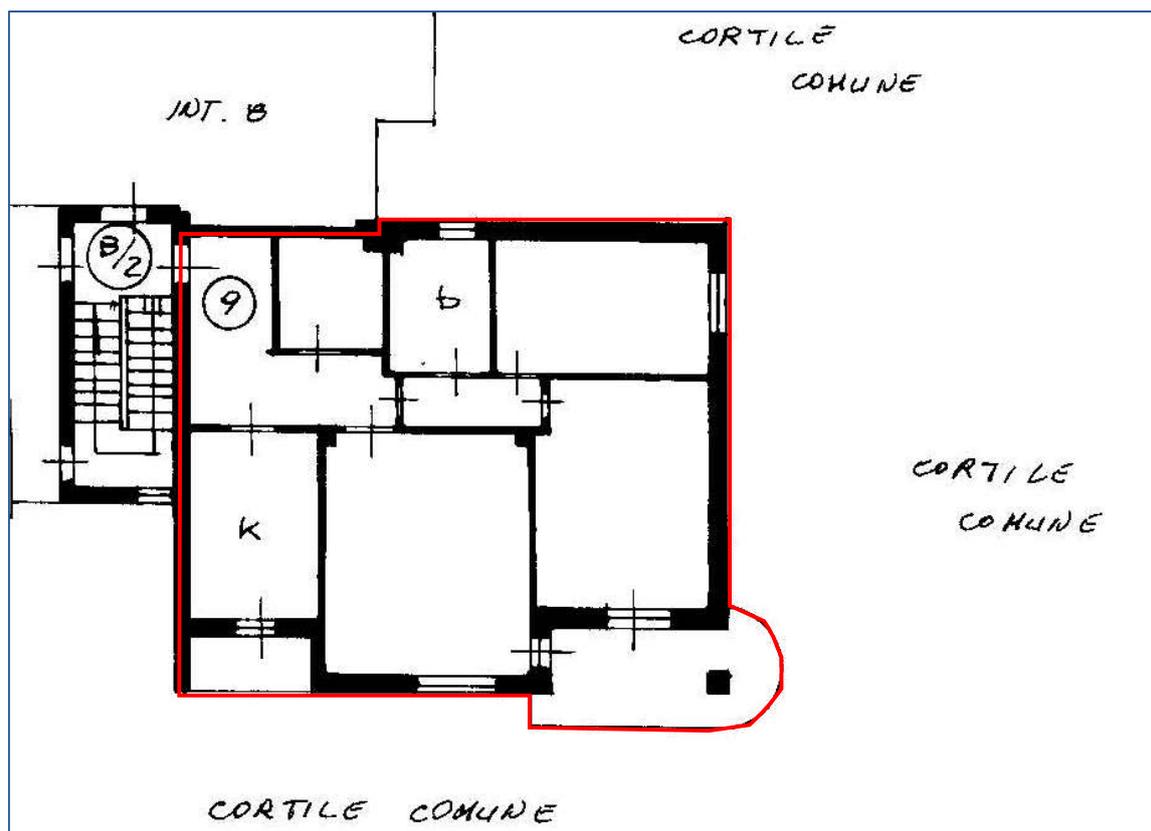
Estratto della planimetria catastale - schema planimetrico rilevato
